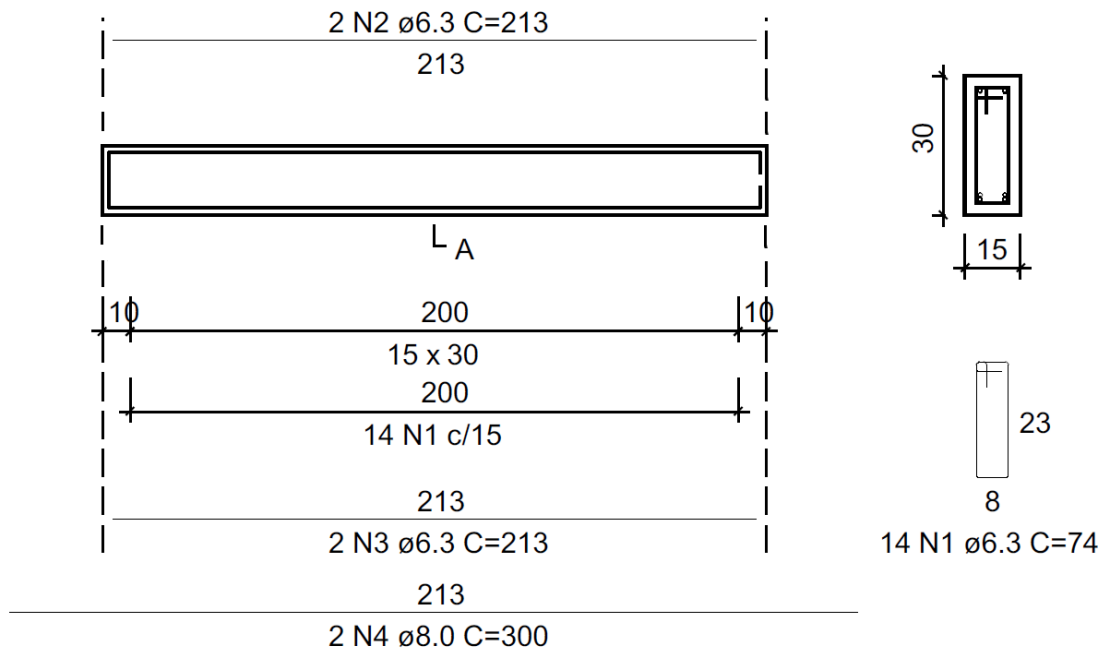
Detalhamento das vigas 1 e 2 (cotas em cm)
